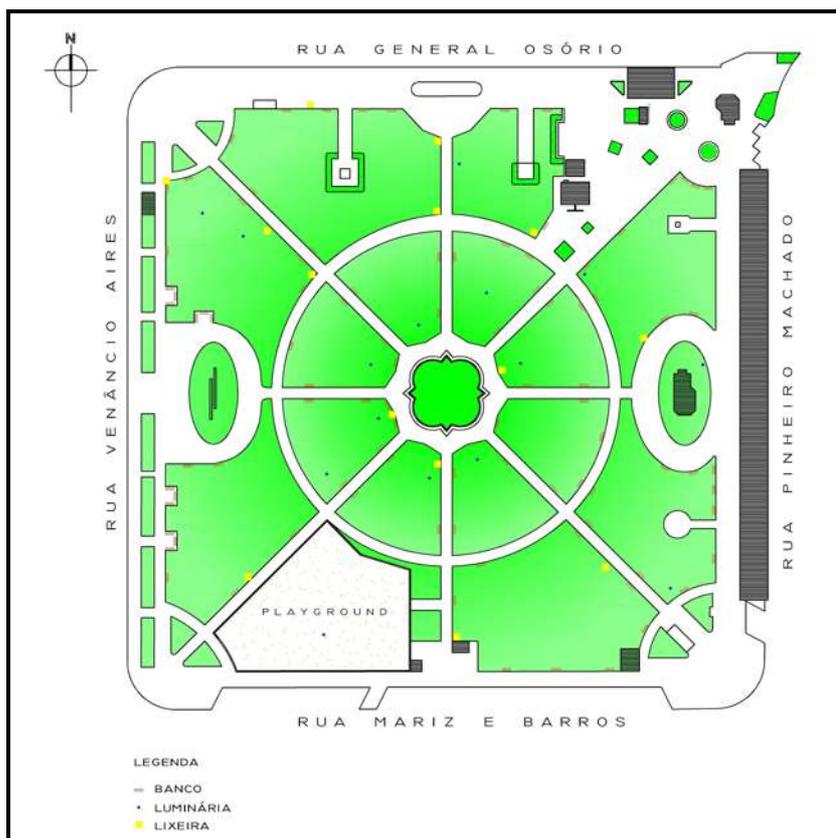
Planta baixa Praça Gal. Firmino de Paula.
